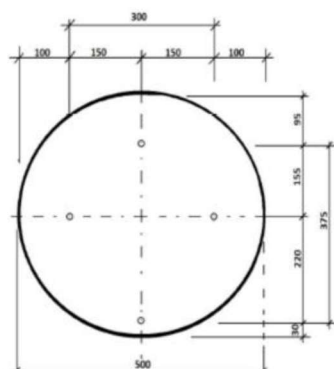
Detalhe do Dispositivo Anti-Giro e da Fundação
